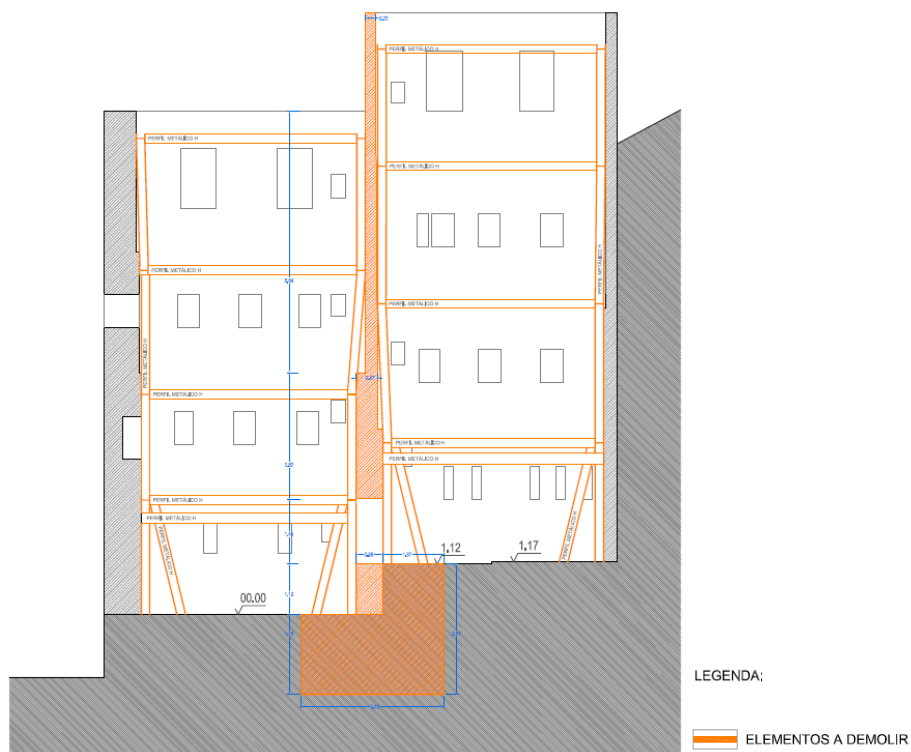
Corte C1 com elementos a demolir - Fonte: Desenhos de Arquitetura da Operação E2 - Projeto 9
